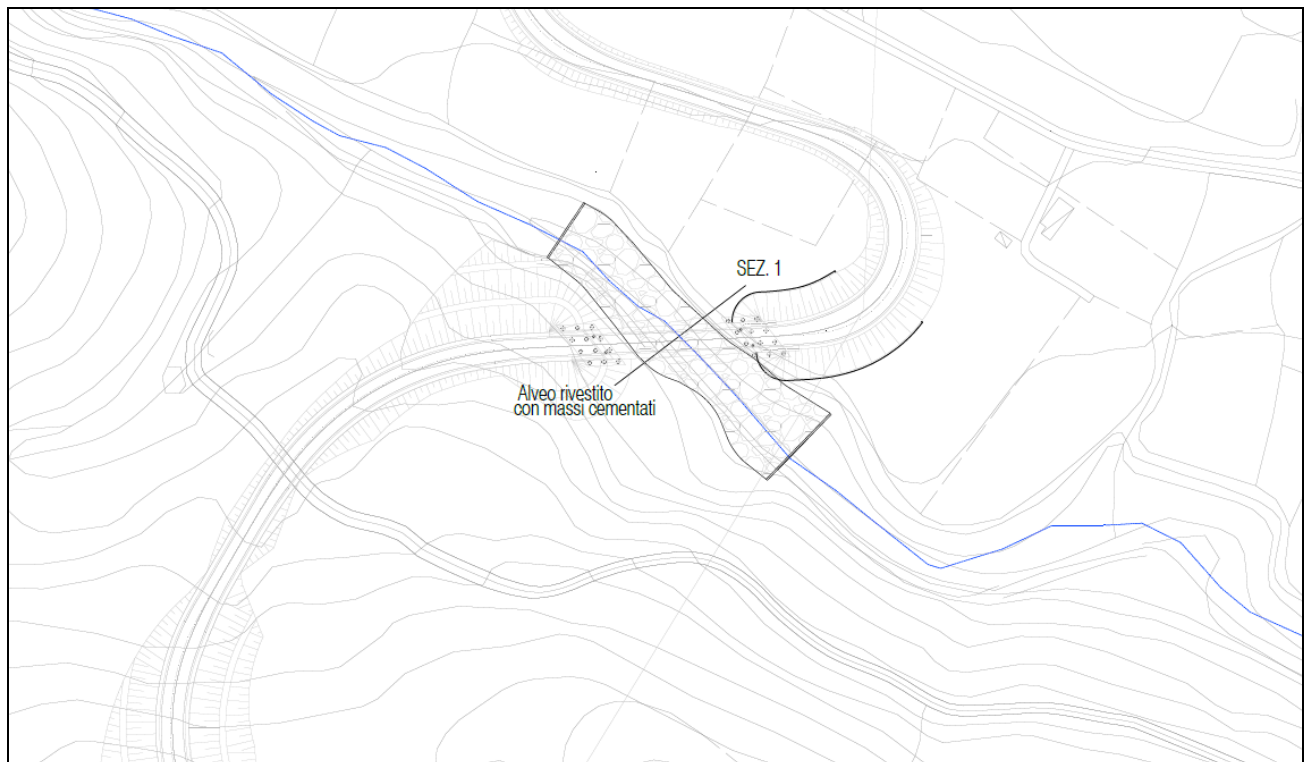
Pianta attraversamento stradale Rio Aiveglia
